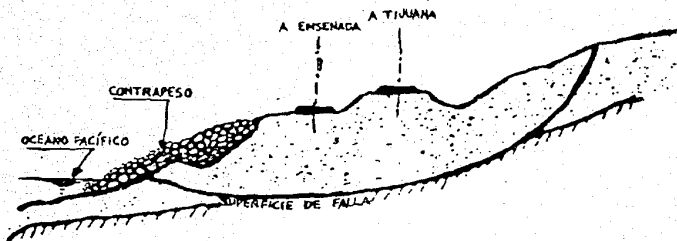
Contrapeso de enrocamiento. Km 12 + 360 de la autopista Tijuana-Ensenada.
